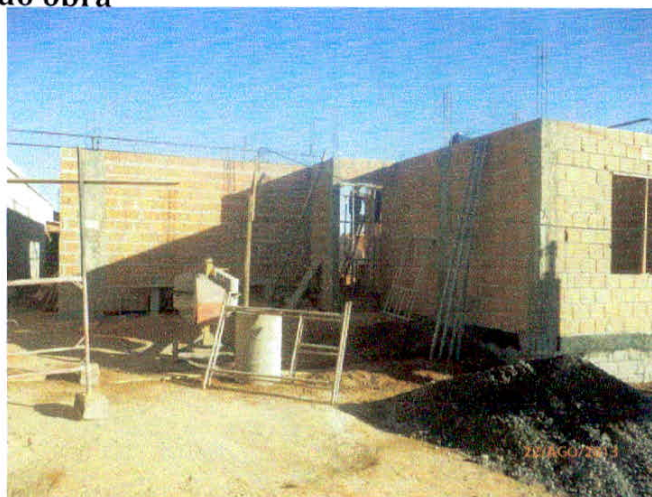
Alvenaria Pavimento Térreo. Data: Agosto/2013
